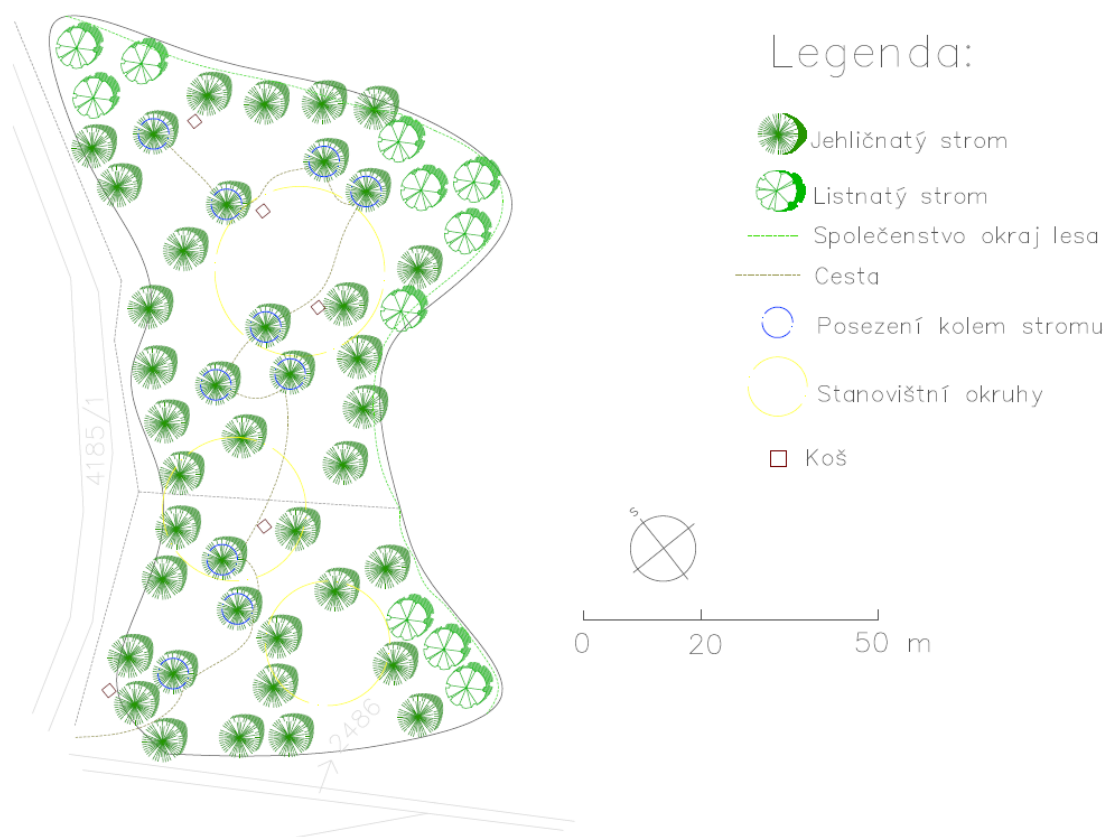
vzor 3220 (zdroj: ČVUT)
